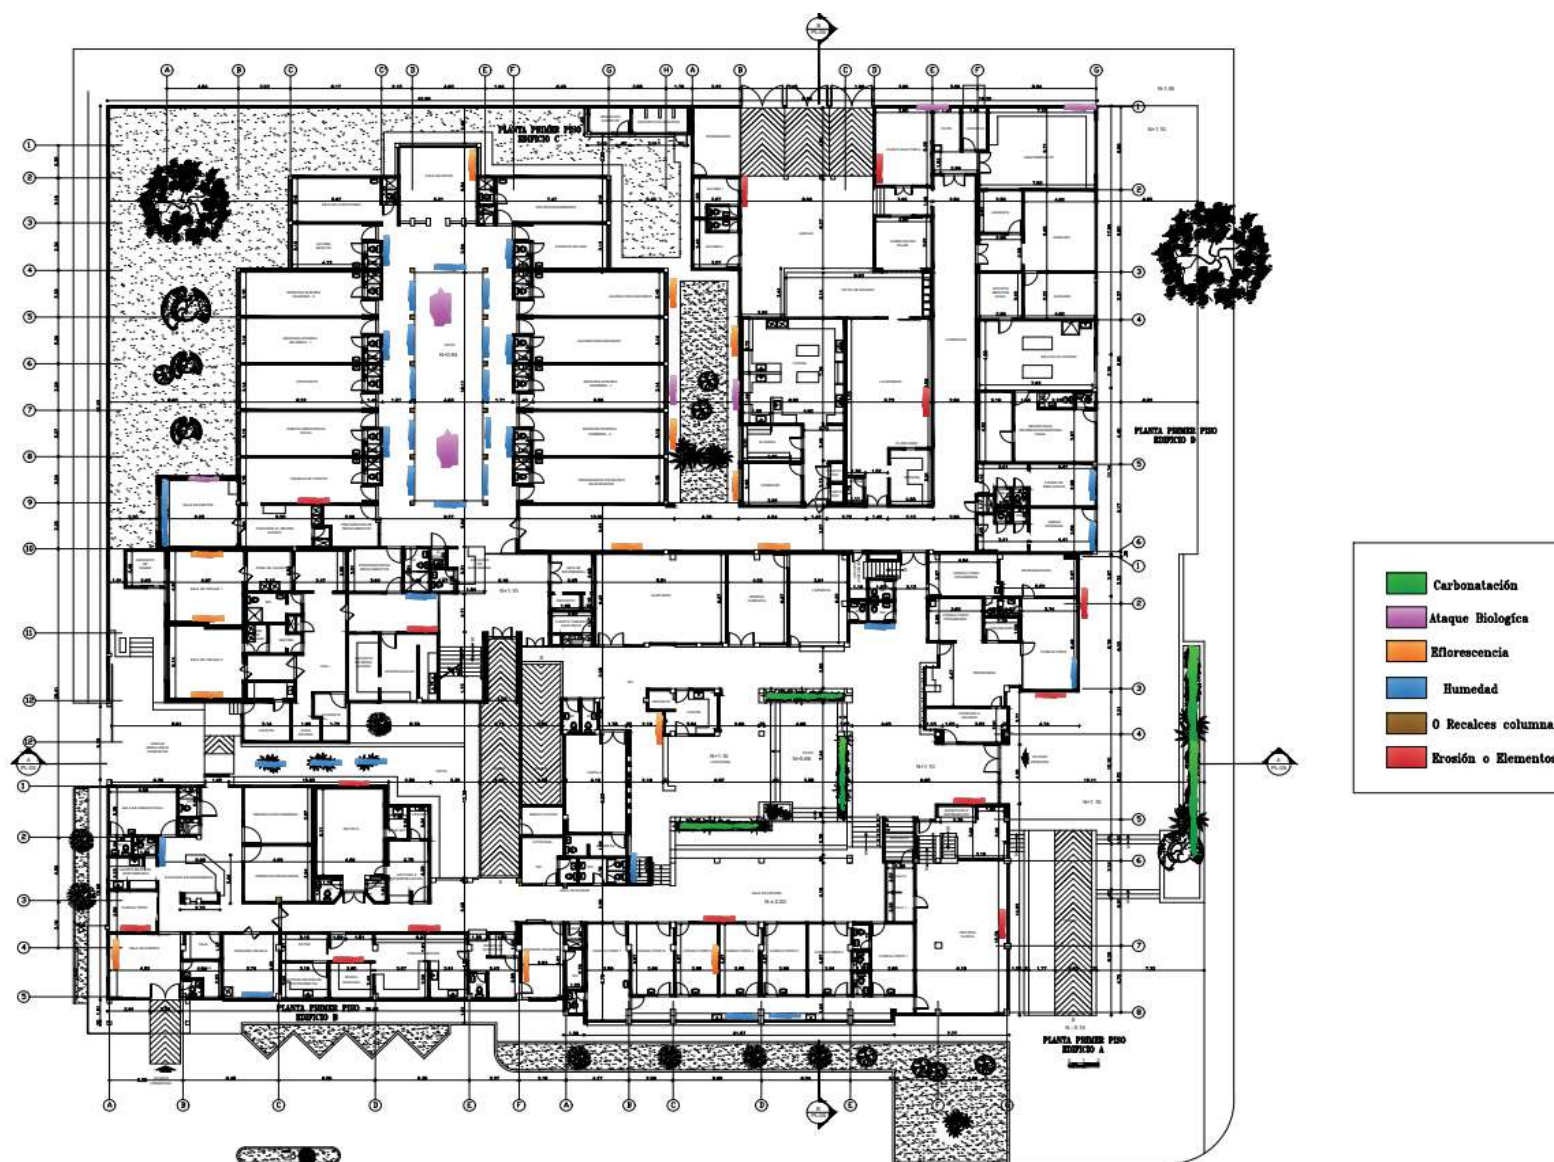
Plano 2 Plano de Calificación Planta Segundo Piso. Fuente: Elaboracion propia
